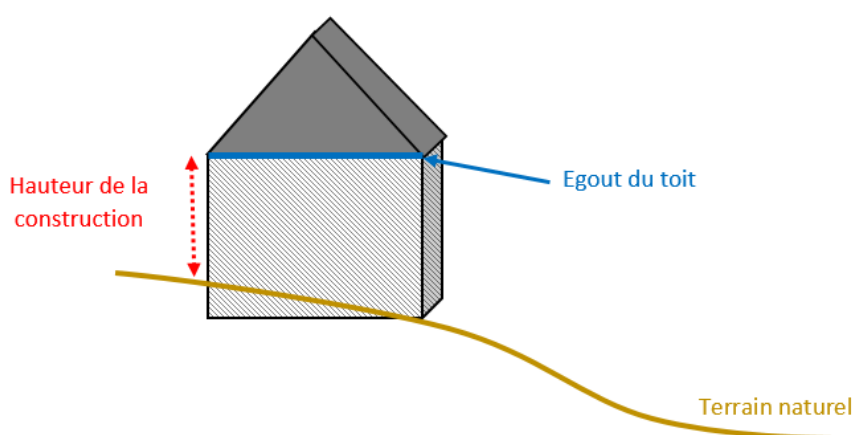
Mesure de la hauteur de la construction en zone 1 AU
